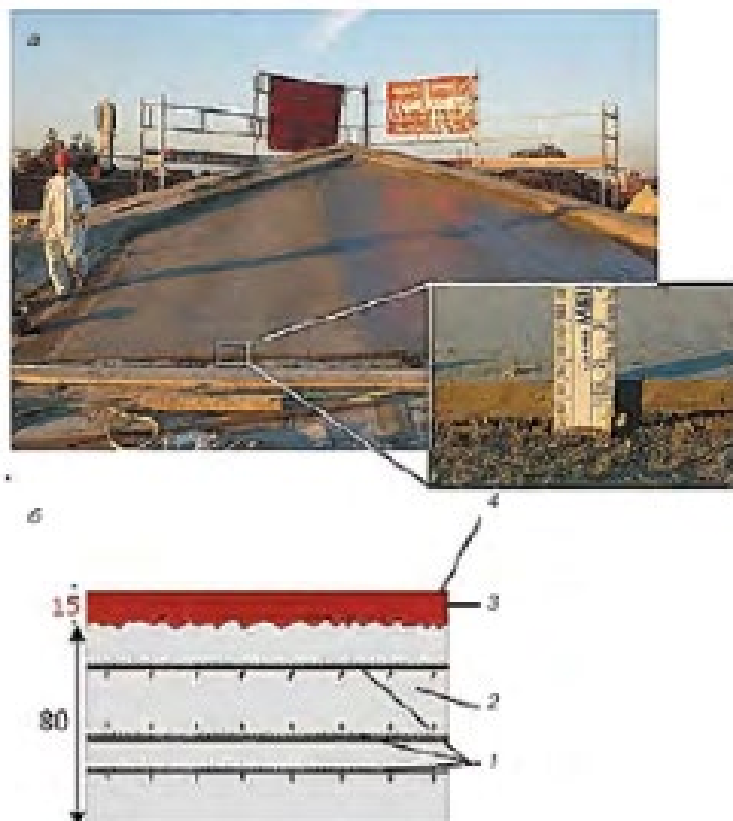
Уложенный текстиль бетон: а – схема усиления текстильного бетона; б – 1) стальная арматура, 2 – старый бетон, 3 – слой текстильной сетки, 4 – слой мелкозернистого бетона [3]
